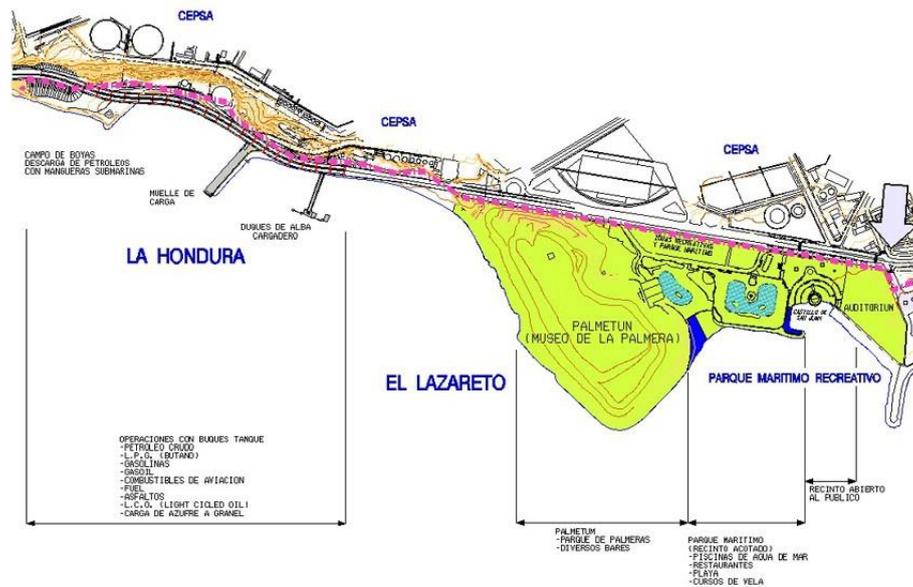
Plano dársena de La Hondura. Fuente: (12)
